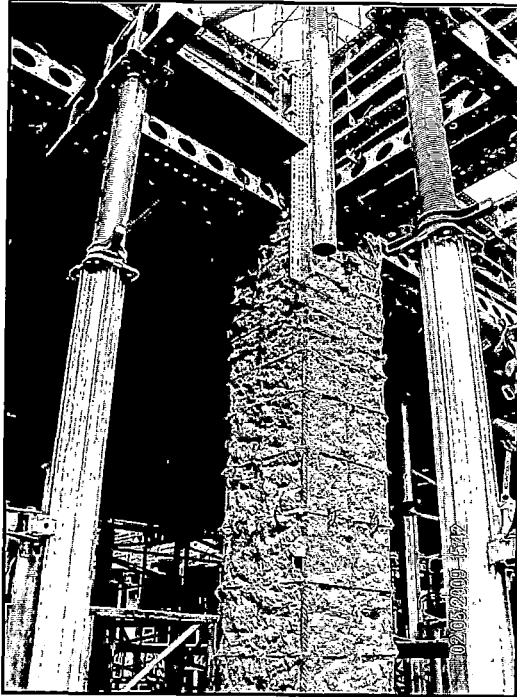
VISTA DE COLUMNA PICADA PARA REFORZAMIENTO.
